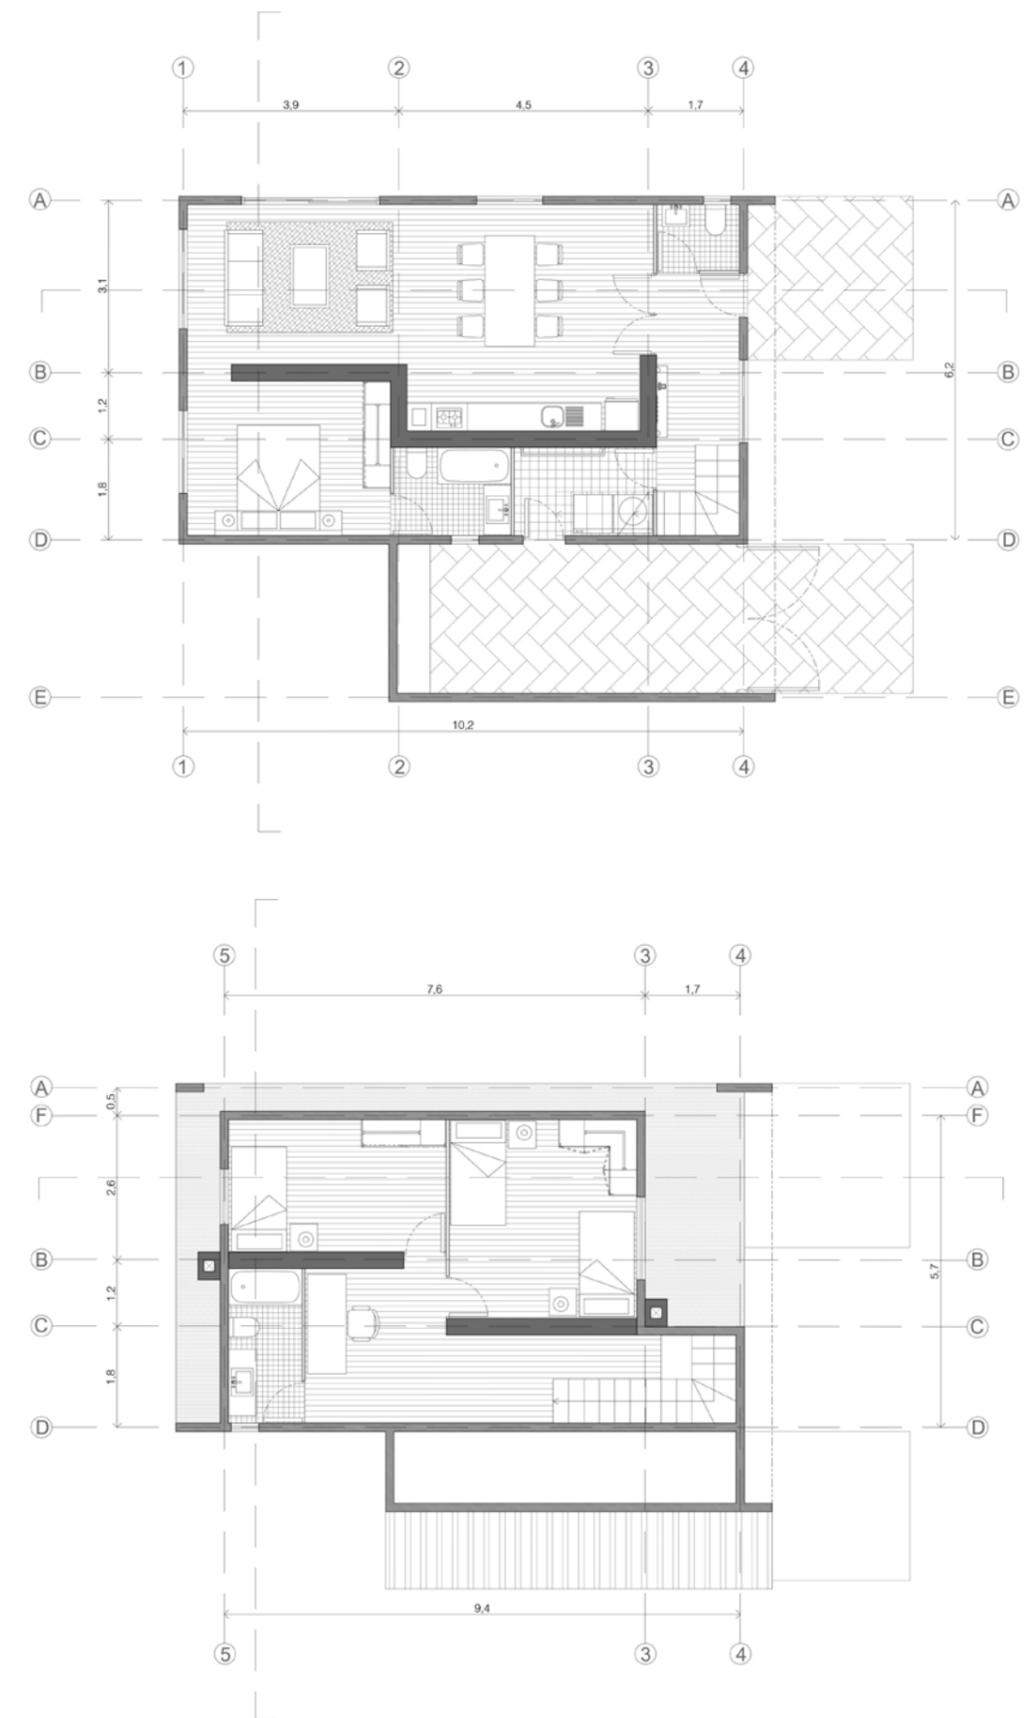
Planimetría Vivienda Propuesta Plantas Primer y Segundo Piso
